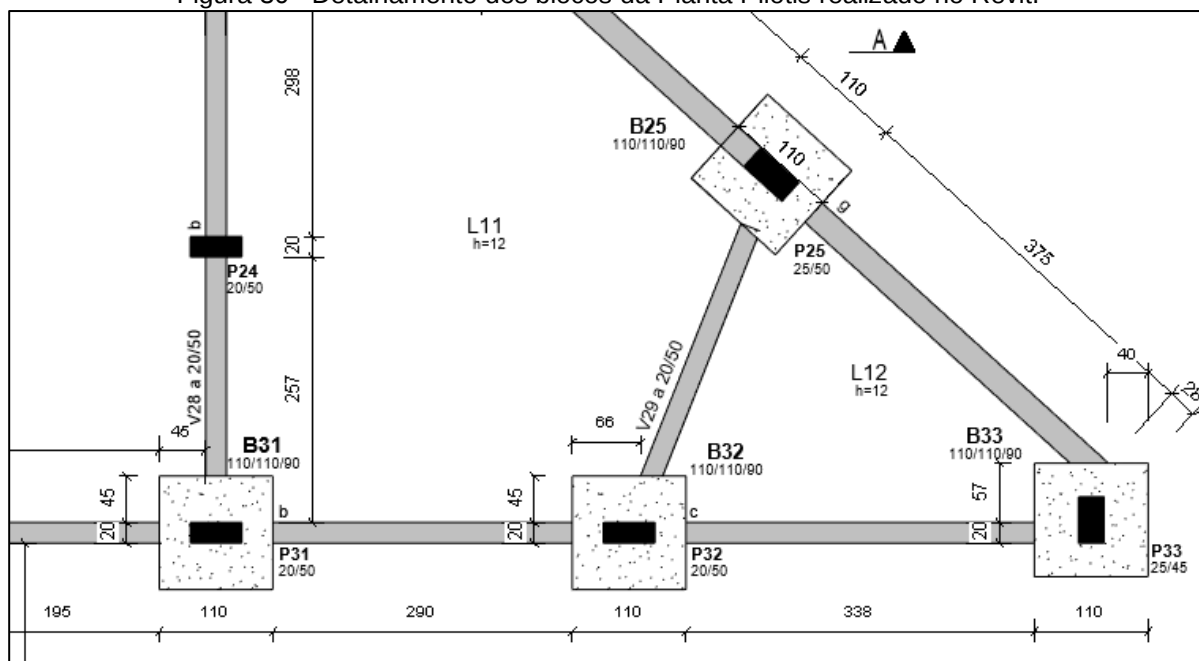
Parte da Planta de Forma Pilotis detalhada no Revit. Detalhe de Lajes, Pilares, Vigas e Blocos com suas respectivas cotas.
